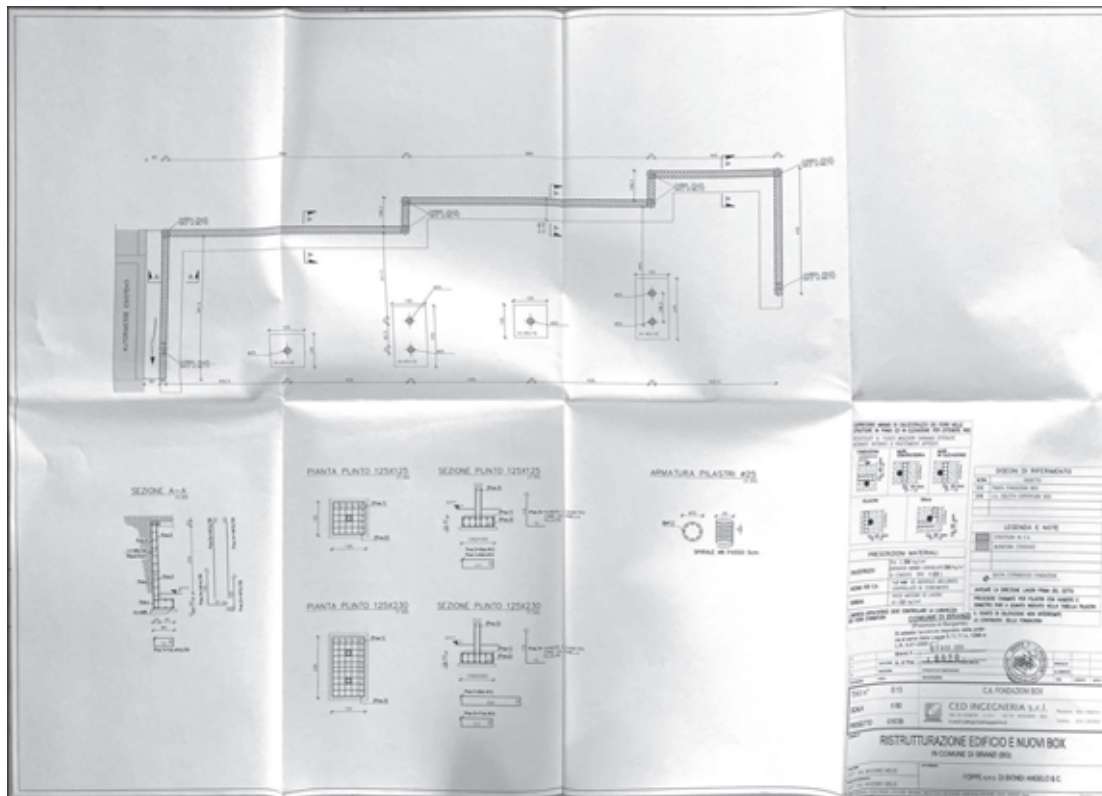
Pianta con indicazioni e specifiche c.a. dell'elevazioni dell'autorimessa
